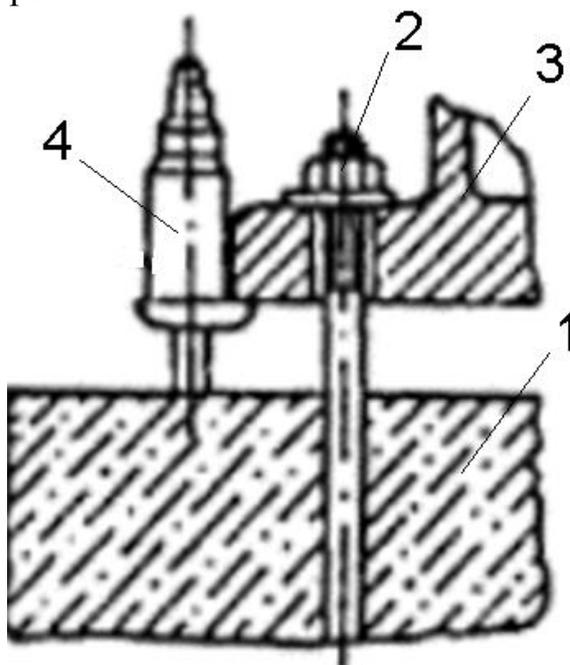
Выверка с помощью домкратов: 1 - фундамент, 2 - анкерный болт, 3 - монтируемое оборудование, 4 - домкрат.
